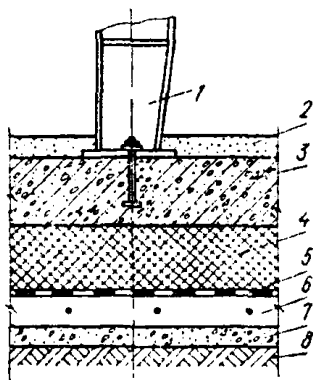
Схема опирания стальной колонны на конструкцию обогреваемого пола
